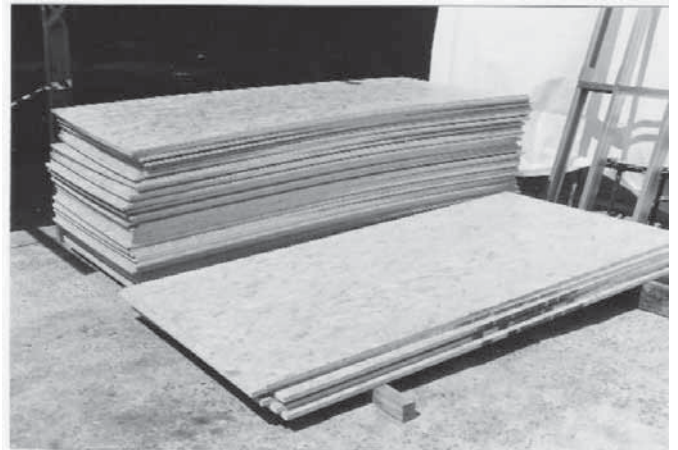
Placas de OSB. (fonte: arquivo do autor)
